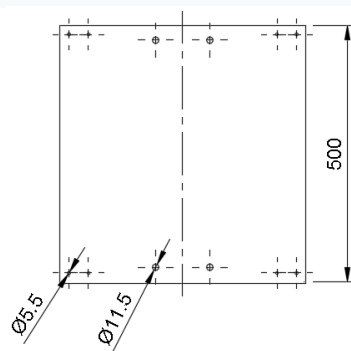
Vista frontal da placa de ACM que será utilizada como parede após o corte.
